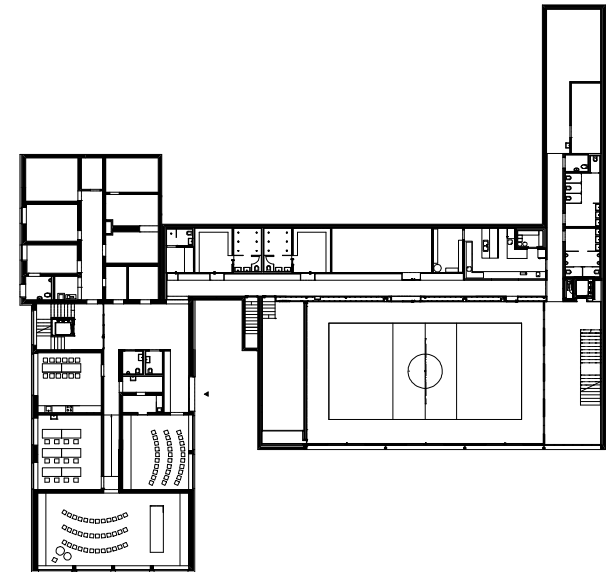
Gemeindezentrum Übersaxen - Grundriss EG
